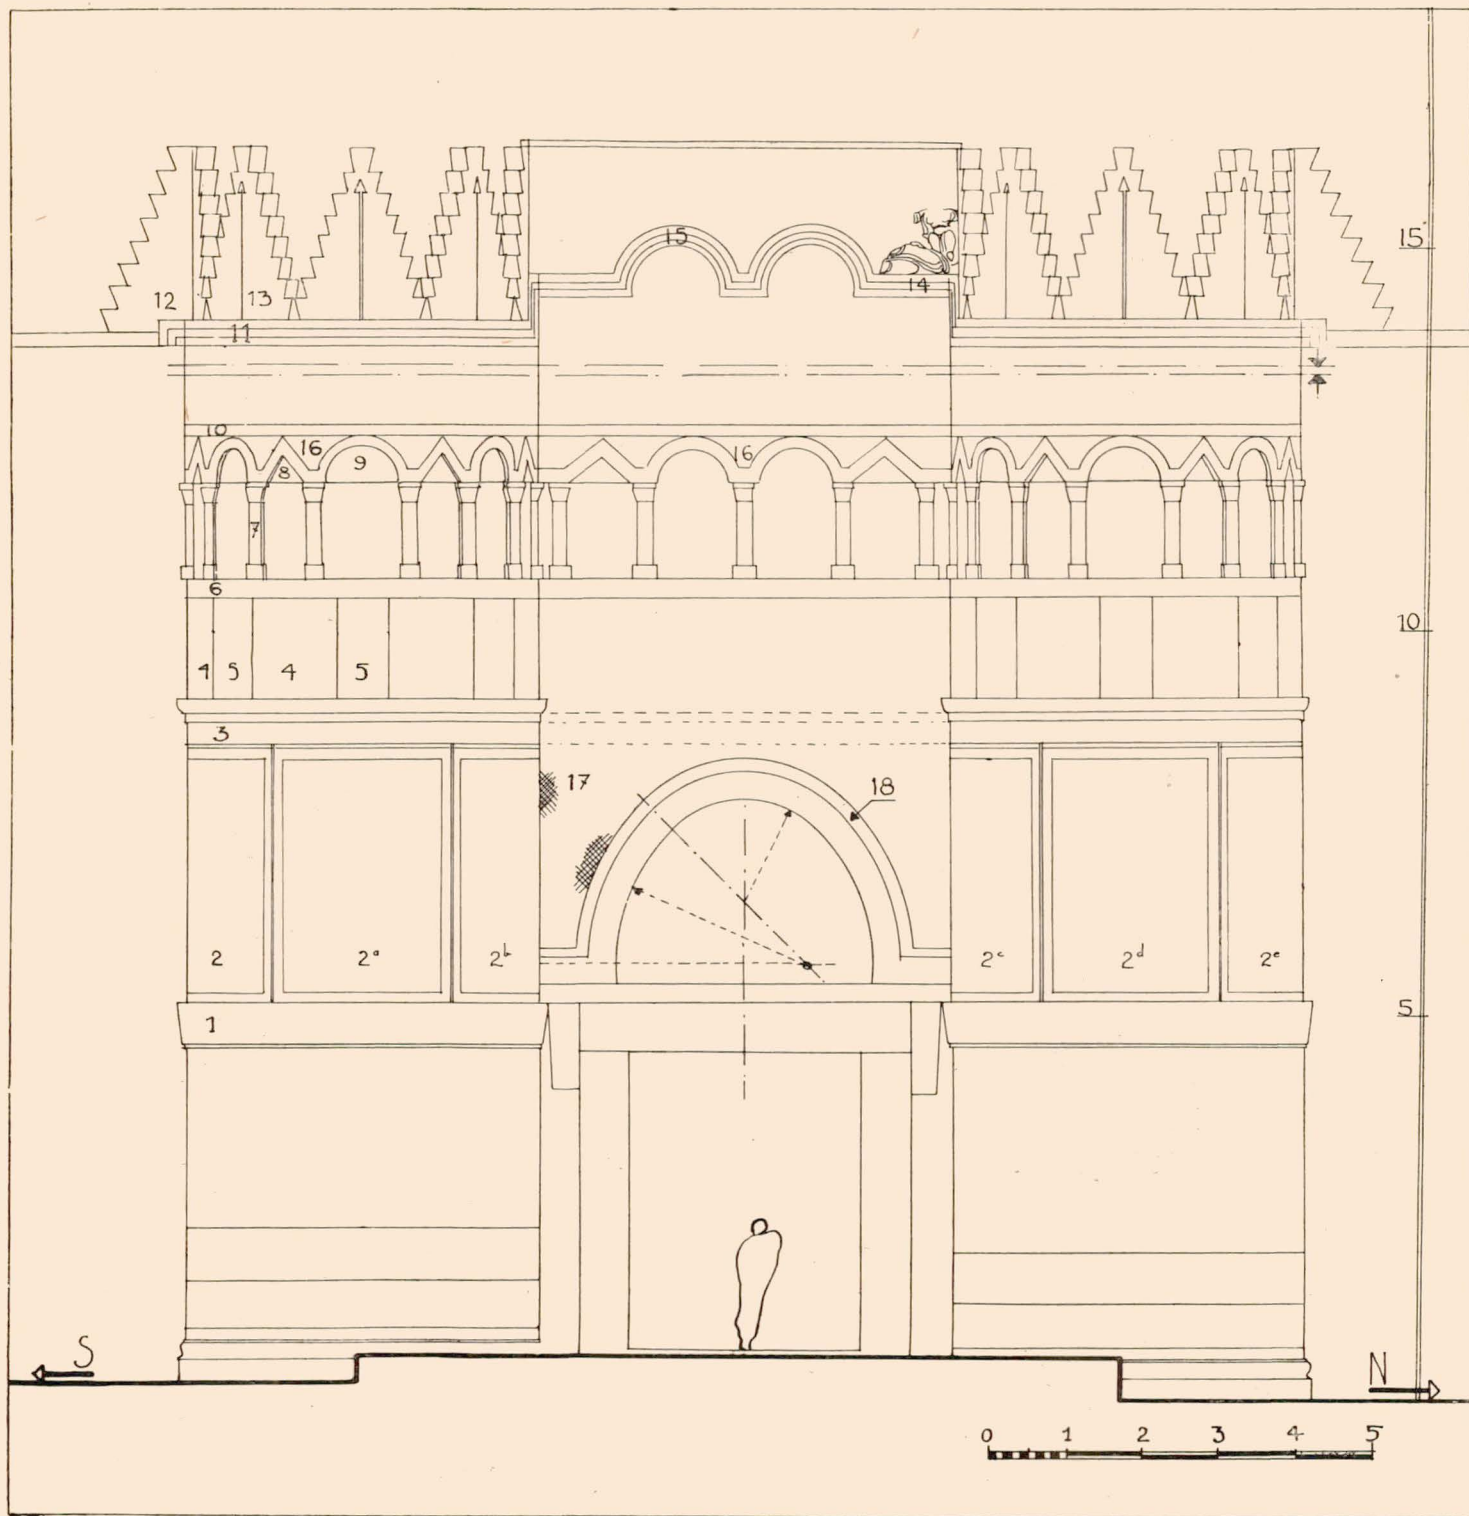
La façade du bâtiment de l'entrée. Essai de restitution.
